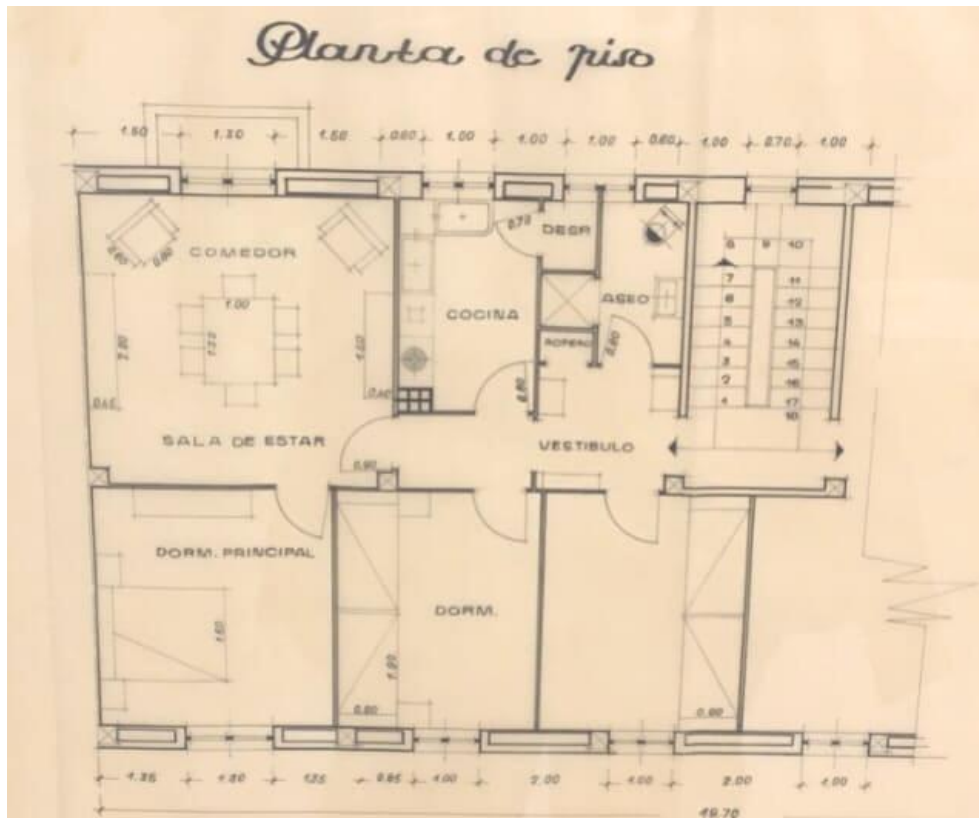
Planta tipo viviendas Federico Mayo. Fuente: Fundación Goerlich
